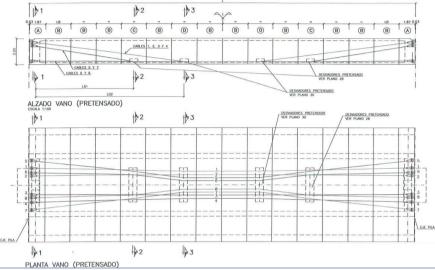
Alzado y planta del vano tipo con sus dovelas constitutivas y pretensado exterior
